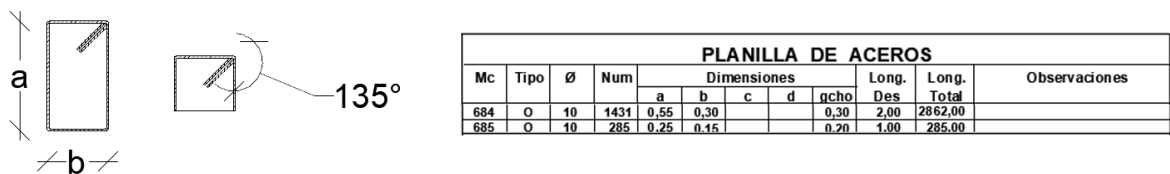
Geometría estribo tipo "O" con gancho. Fuente: Planta Física-PUCE. Modificado por Francisco Redín
